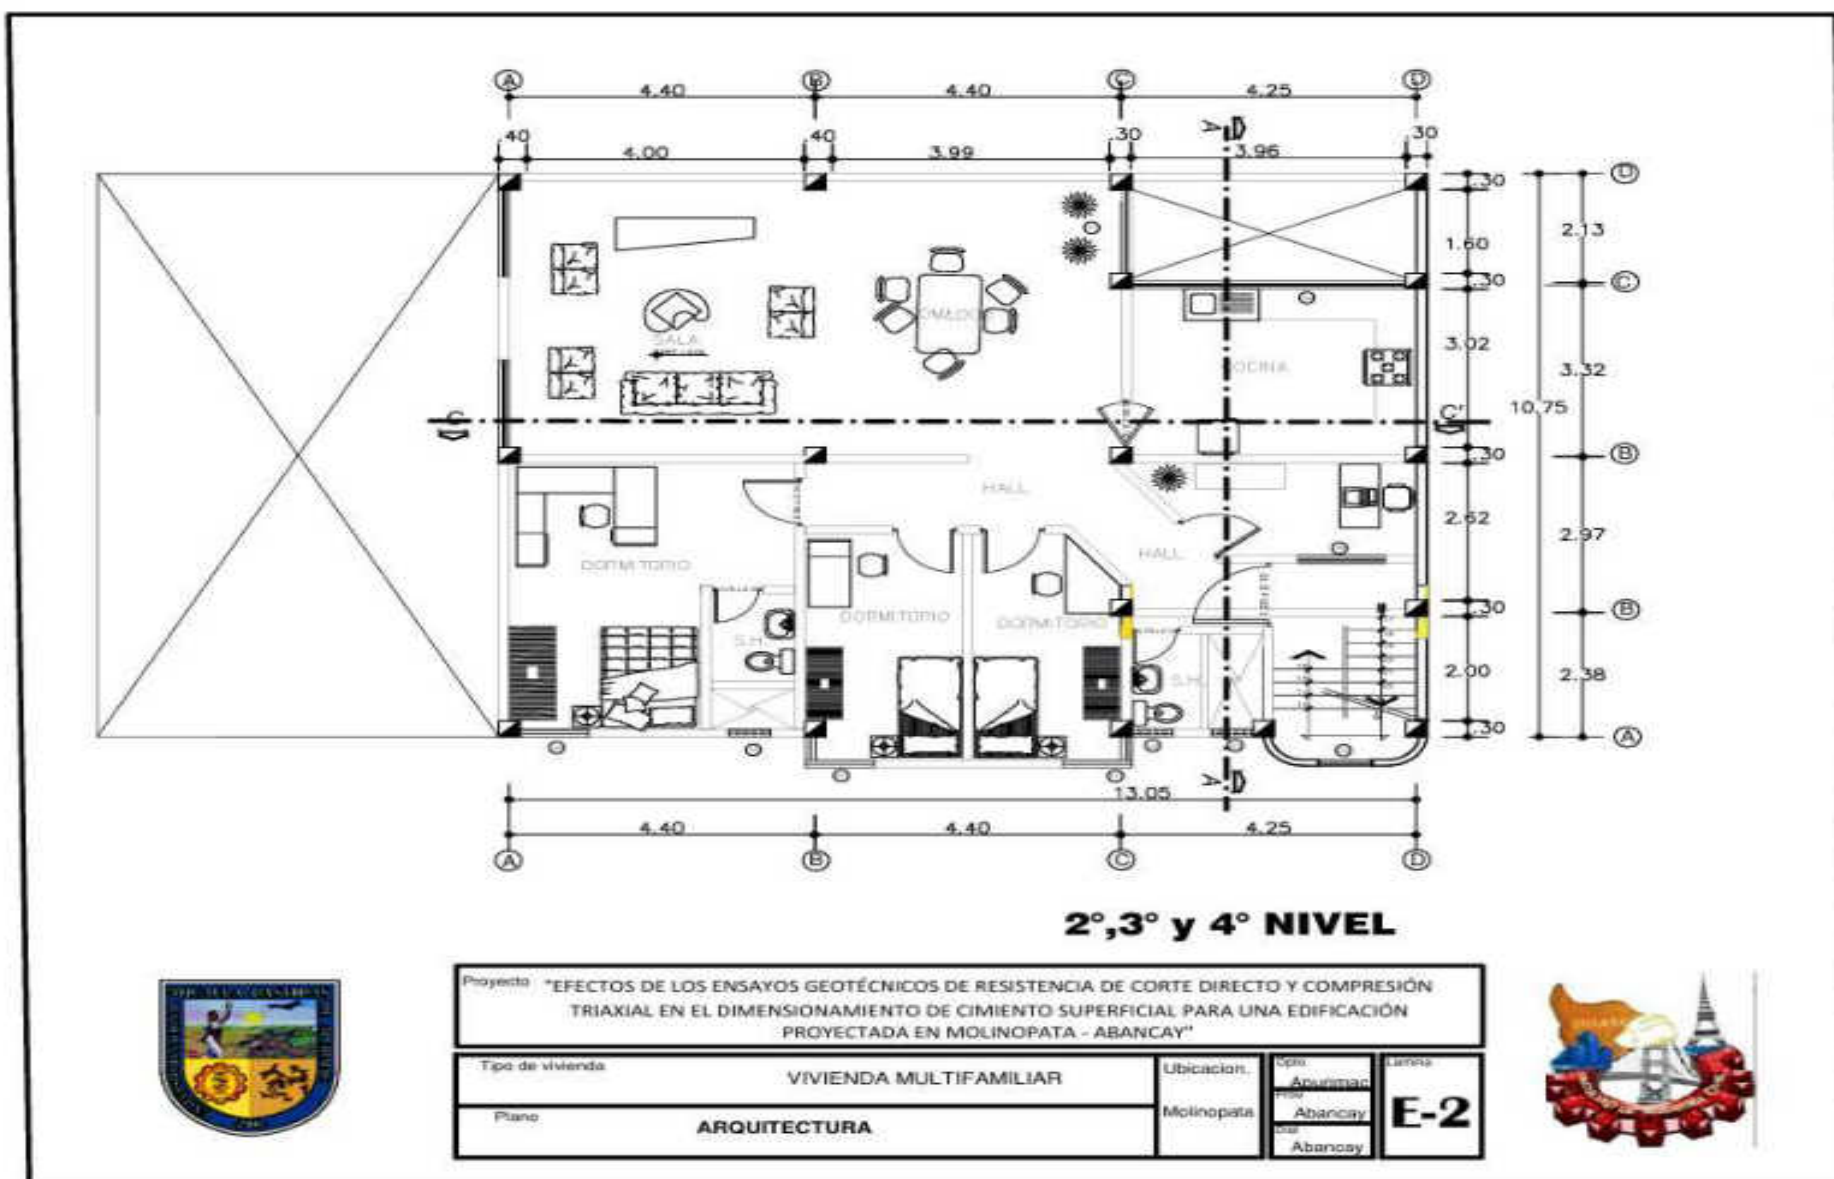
Plano de arquitectura 2°, 3° y 4° nivel
